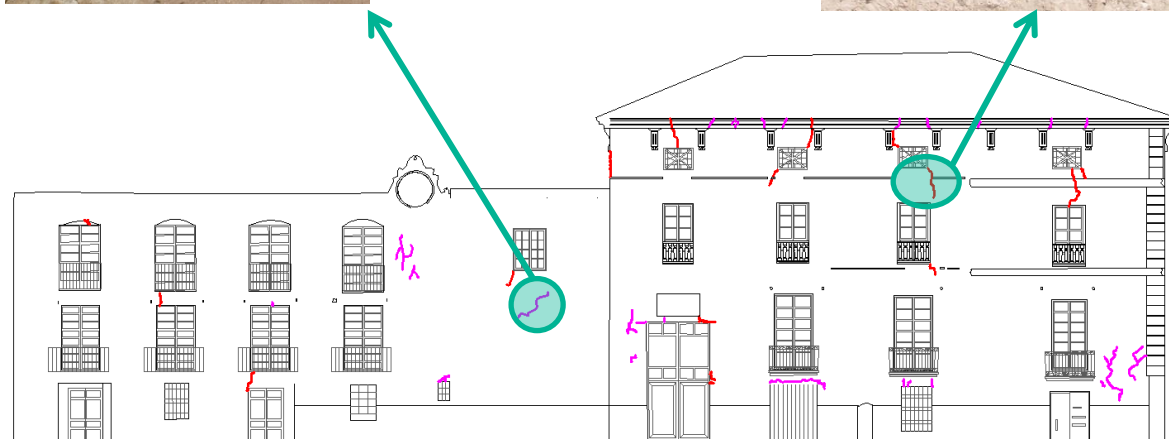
Alzado plaza. Ejemplo grieta y fisura. Fuente: Elaboración propia
